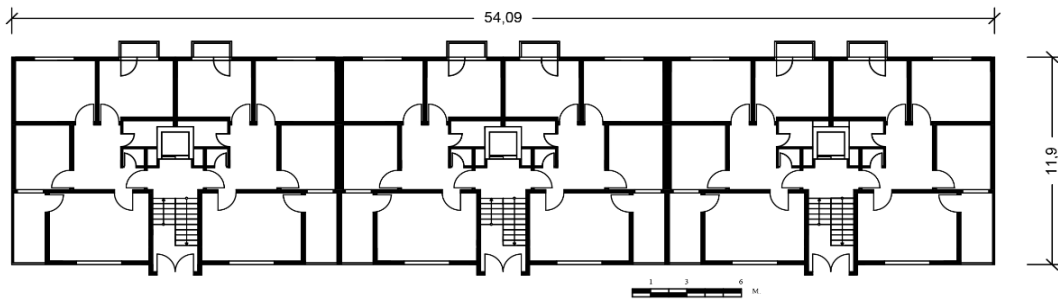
Geschoss Wohnungsbau (Apartment) im Plangebiet.¹⁹⁰
